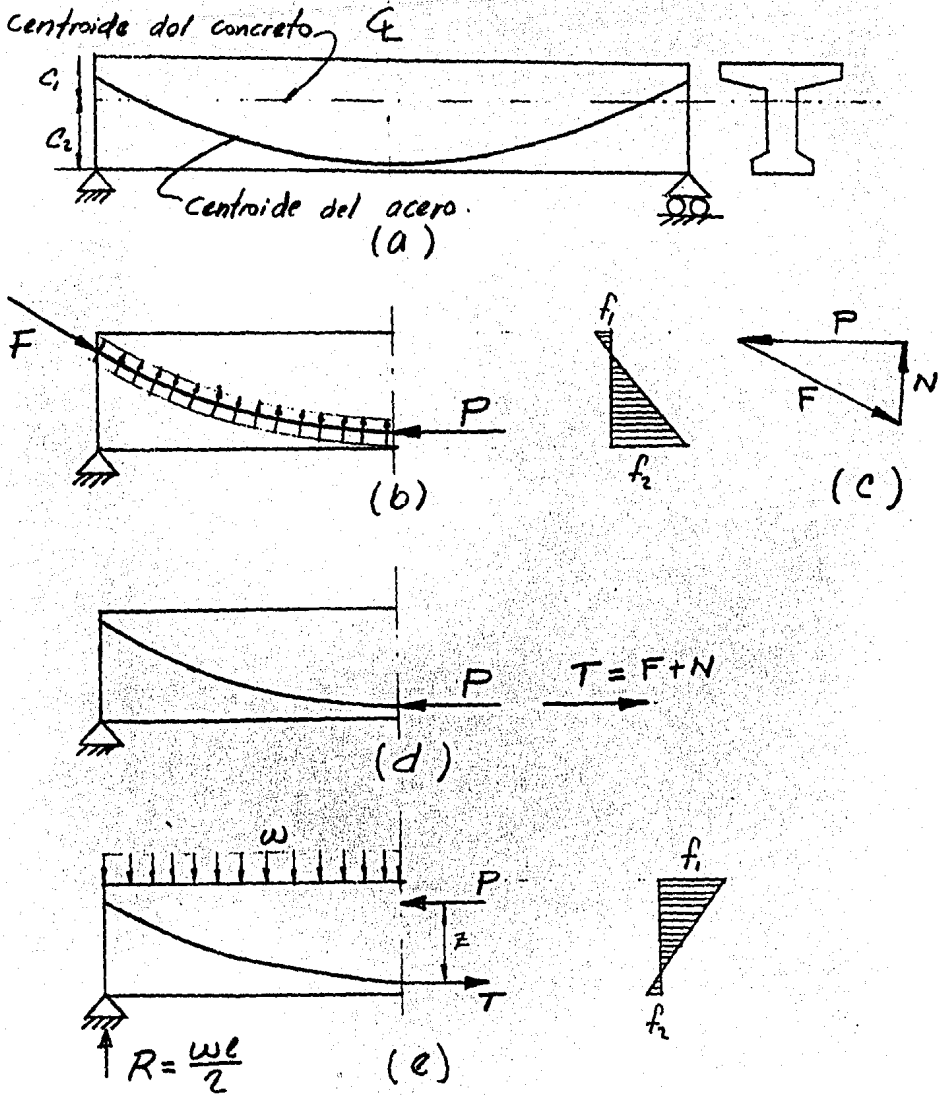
Fuerzas que actúan en una viga presforzada típica. (a) Perfil de la viga y su sección. (b) Fuerzas que actúan en el concreto. (c) Polígono de equilibrio de fuerzas. (d) Fuerzas de anclaje y curvatura reemplazadas por la resultante. (e) Viga con cargas transversales.
